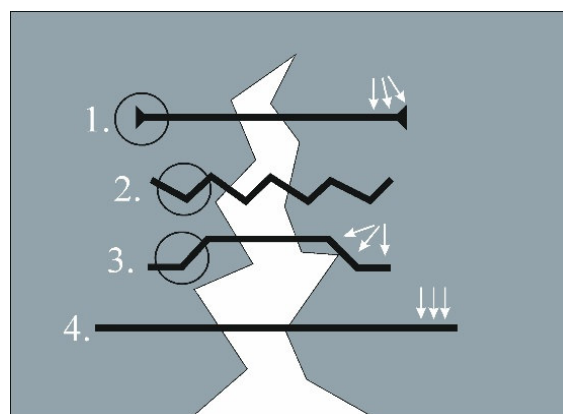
Схема анкеровки стальных фибр различных форм в цементном камне: 1 – фибра с конусовидными концами; 2 – волновая фибра; 3 – фибра с загнутыми концами; 4 – прямая фибра: кружки – механизмы анкеровки фибры; стрелки – поверхности сцепления
